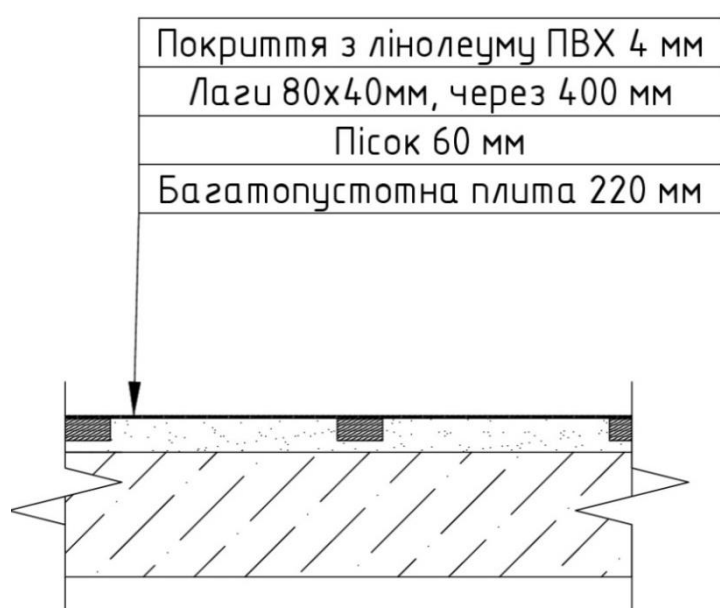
Схема монтажного положення багатопустотної залізобетонної плити перекриття
